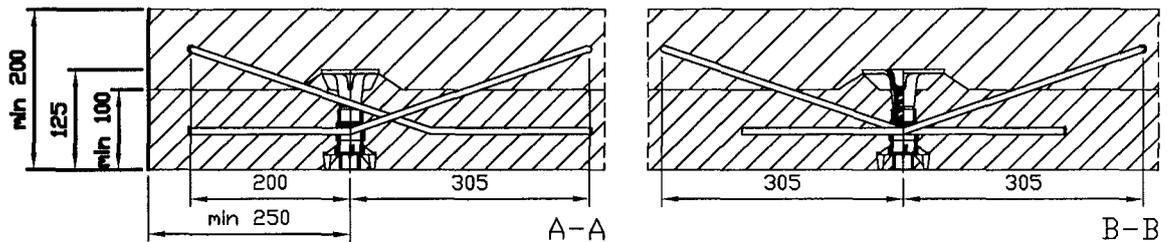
Einbau Fertigteilquerschnitt FT mit Ortbetoneergänzung
